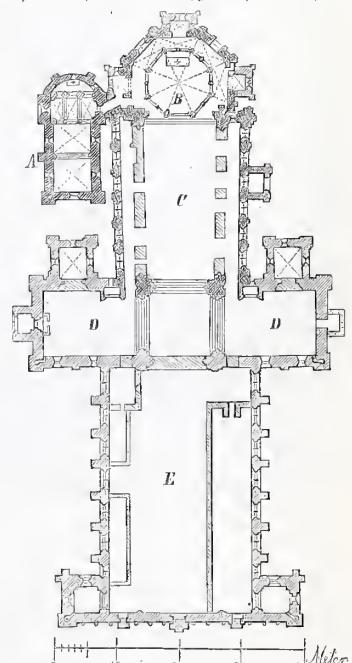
Dom zu Drontheim (Grundriss).
